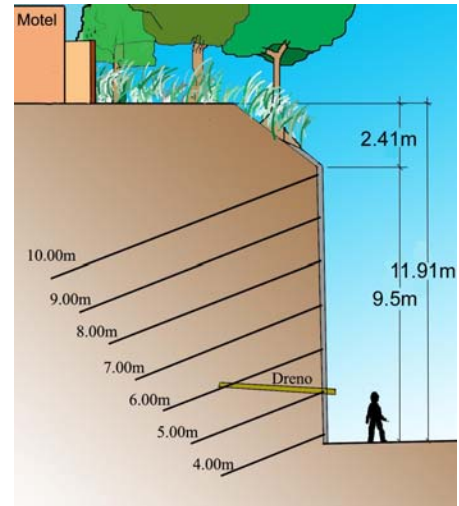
Corte esquemático do projeto, Rod. Anchieta
